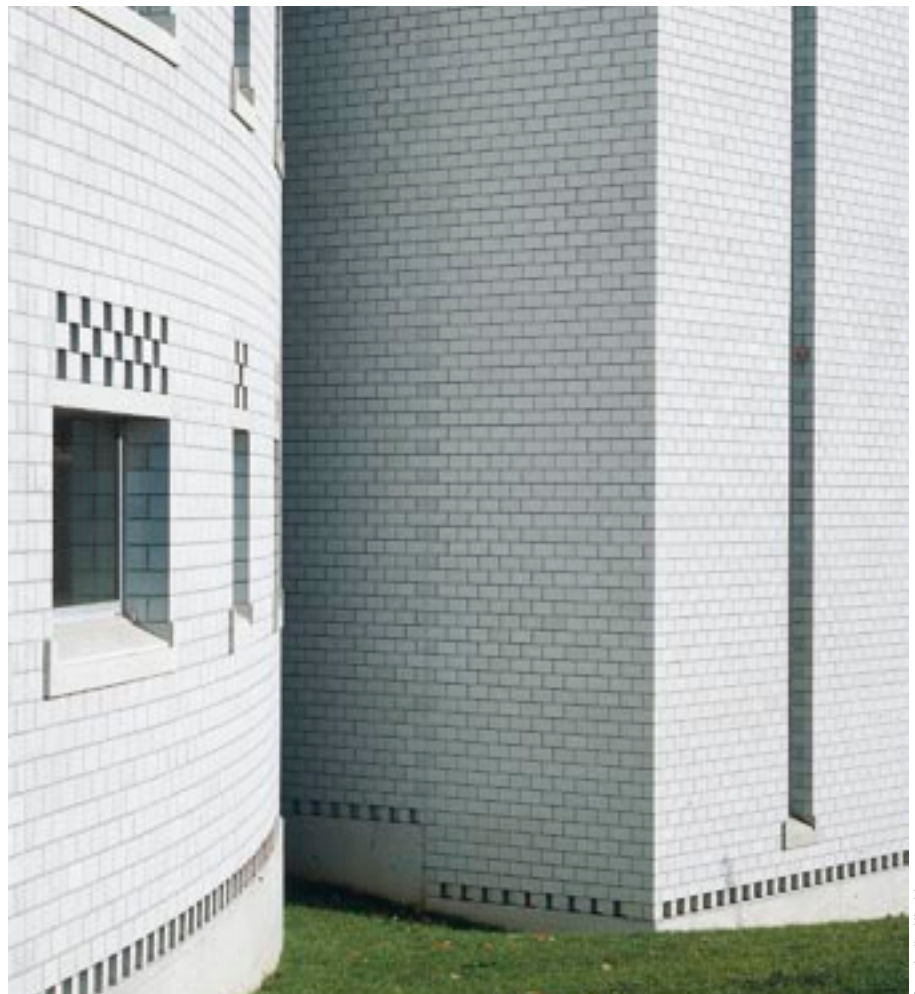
Strenge geometrische Gliederung der Baukörper durch KS-Außensichtmauerwerk
